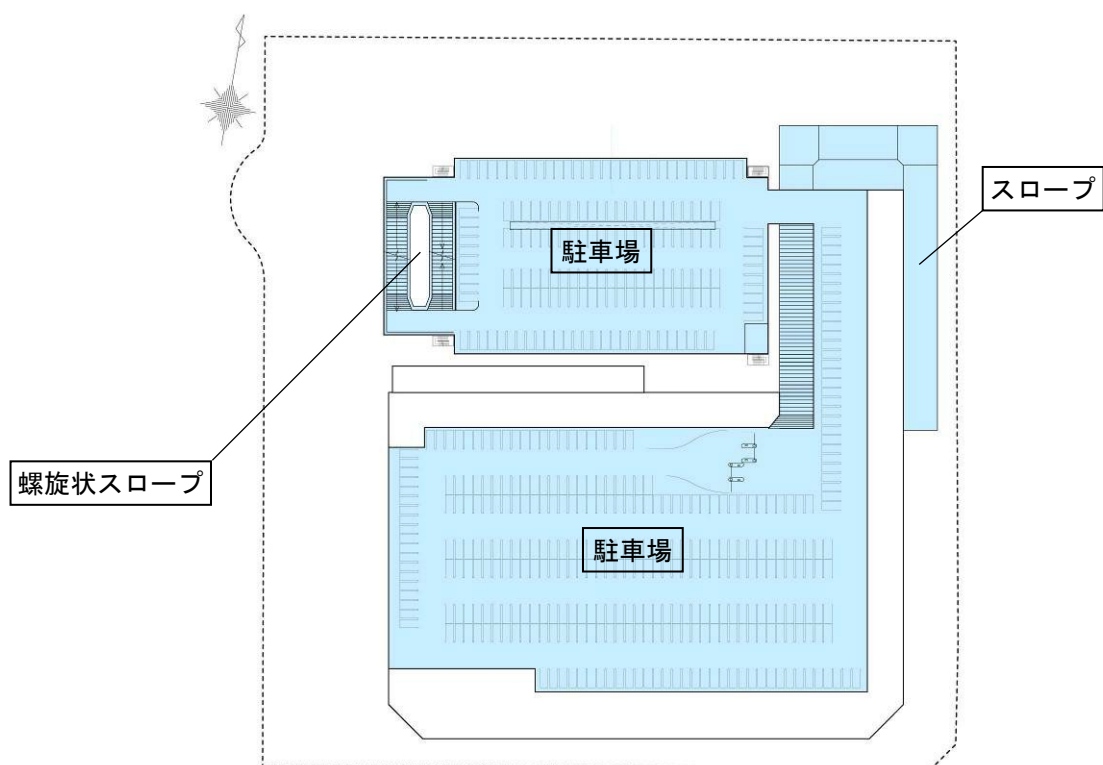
(5) 各階平面図(屋上階) 【評価書時】
